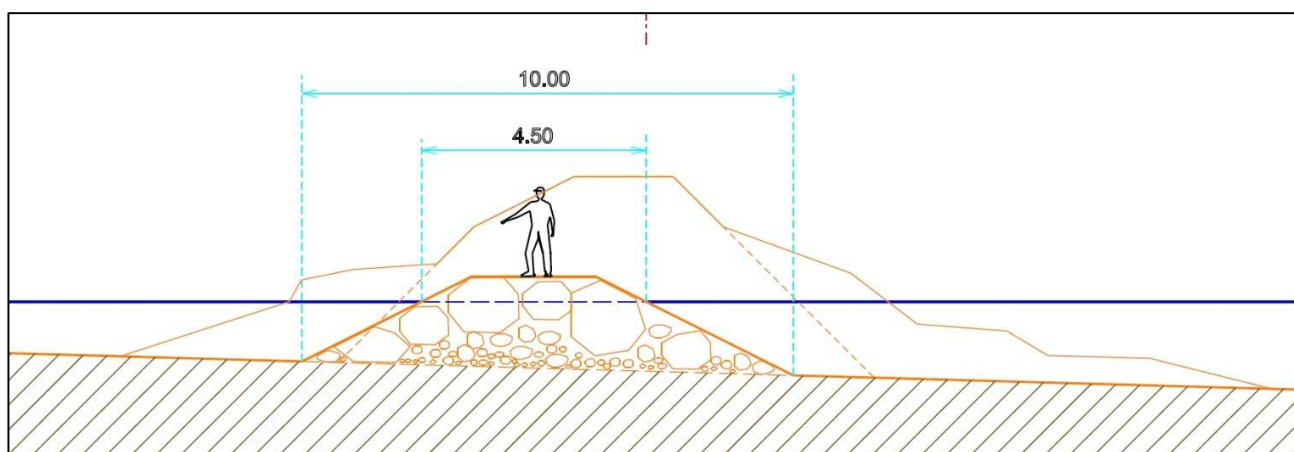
Sezione tipo trasversale delle estremità laterali dell'isolotto A
